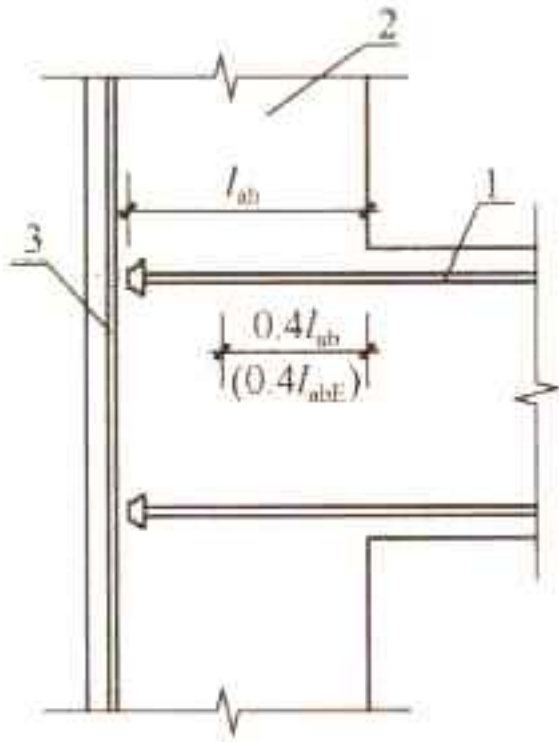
钢筋锚固板在边缘构件中的锚固示意图
